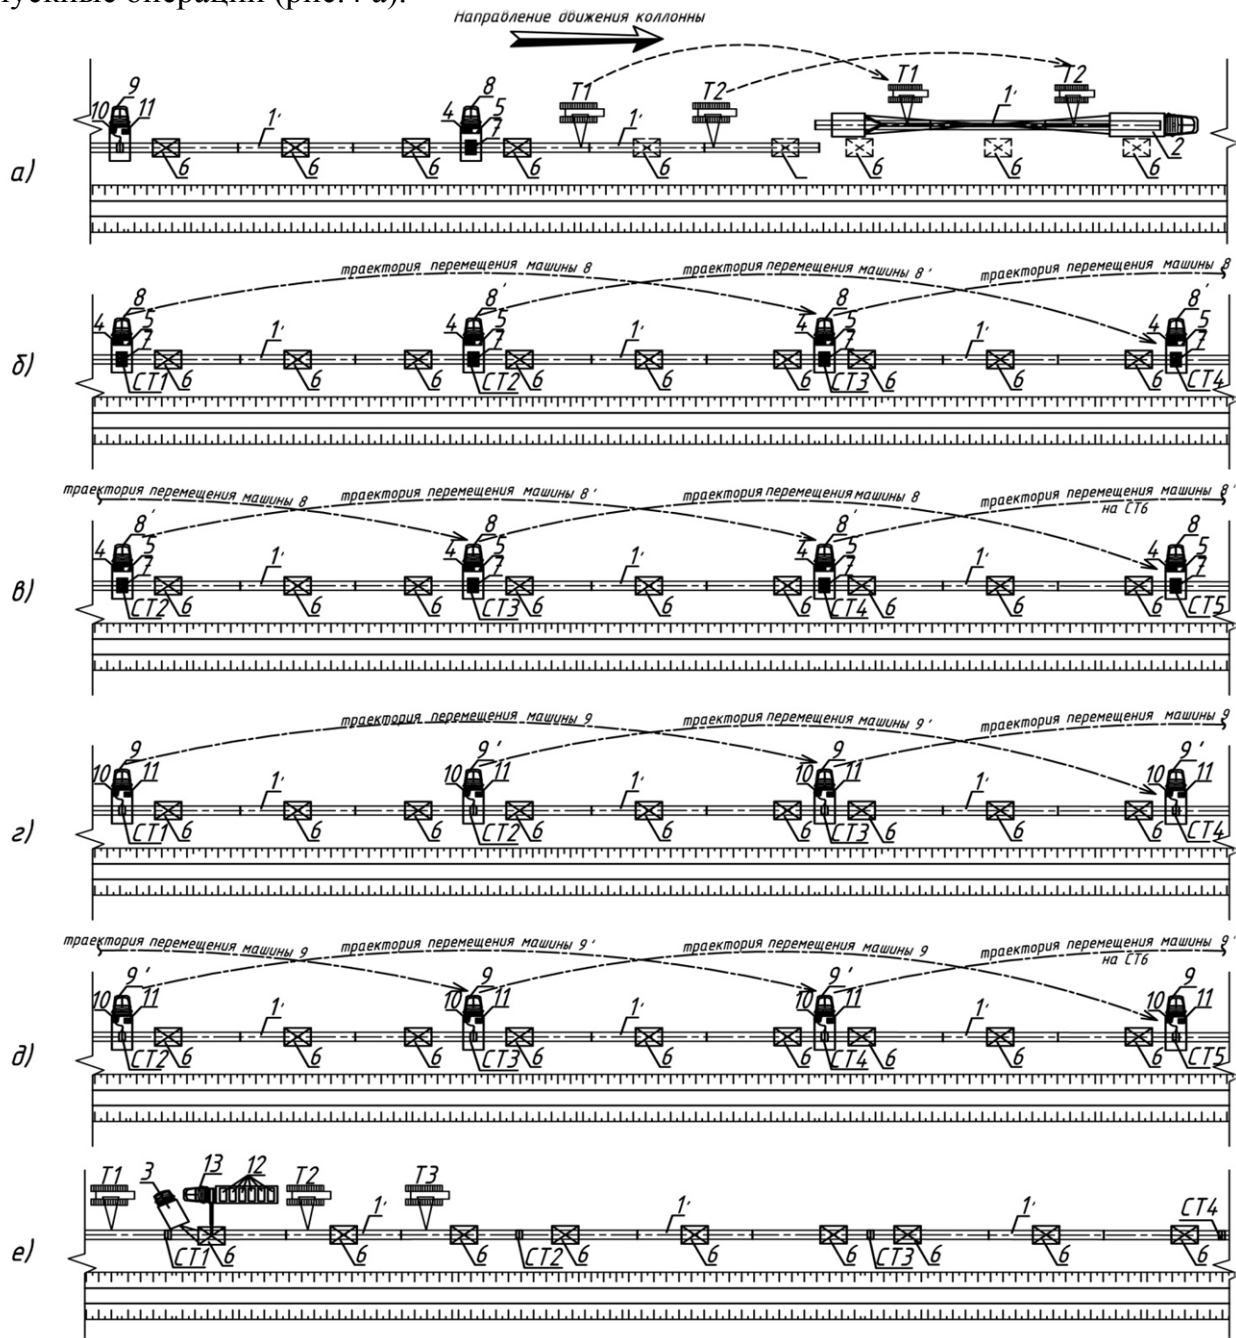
Комплексная технологическая схема сооружения магистрального трубопровода из плетей на бровке траншеи с применением монтажных опор при а)- разгрузки плети и укладки ее на предварительно установленные вдоль одной прямой монтажные опоры; б) и в)- осуществлении центровки и сварки плетей с указанной схемой движения машин; г) и д) - осуществлении изоляции стыков с указанной схемой движения машин; е)- замены монтажных опор на инвентарные опоры в процессе ведения монтажа трубопровода из плетей: 1' – плеть, 2 – плетевоз, 3- машина для перемещения монтажных опор, 4 - распределитель для управления монтажными опорами, 5- электрогенератор, 6 - монтажные опоры (пат.на ПМ №147232), 7-автоматическая орбитальная установка для монтажа магистрального трубопровода, 8,8',9,9' - грузовые машины с расположенным в кузове оборудованием, 10 – газовый баллон, 11-изоляционный материал для нанесения на сварные стыки магистральных трубопроводов, 12-инвентарные опоры, 13- манипулятор, Т1,Т2,Т3-трубоукладчики, СТ1,СТ2,СТ3,СТ4- сварные стыки –первый, -второй, -третий, - четвертый соответственно.
